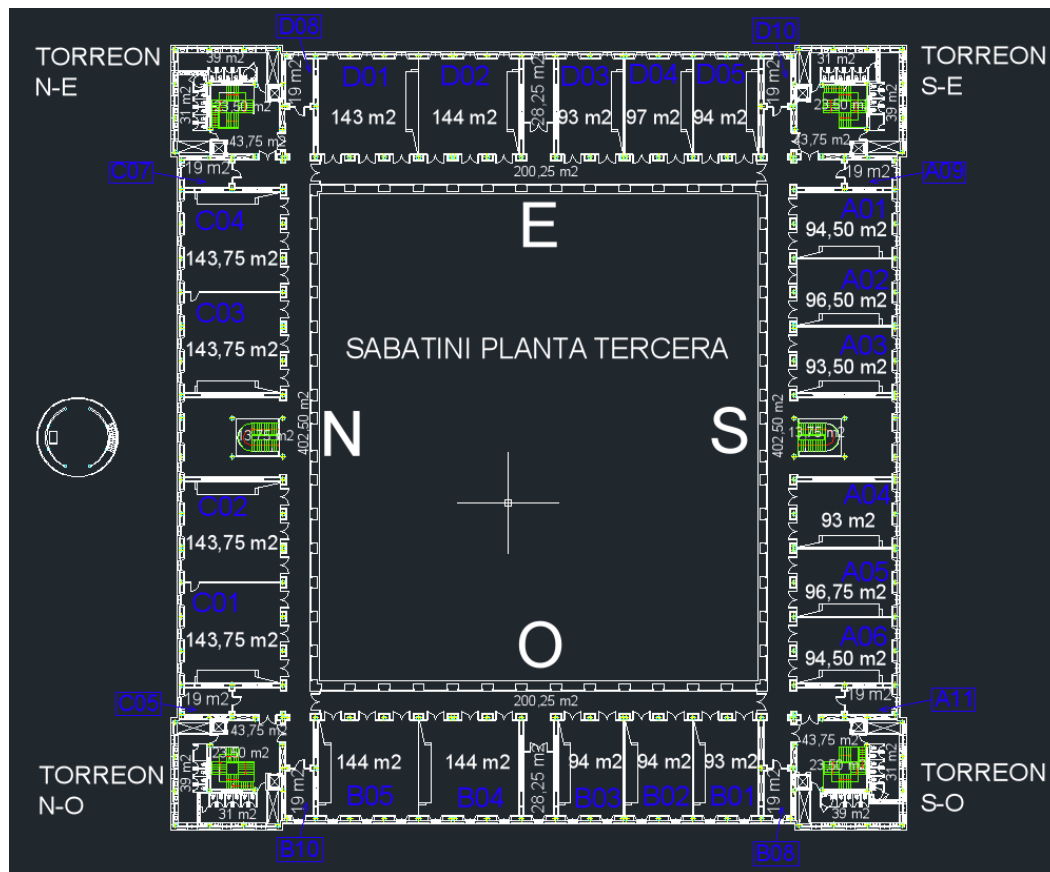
Vista en planta de la planta tercera, edificio Sabatini - AutoCAD
